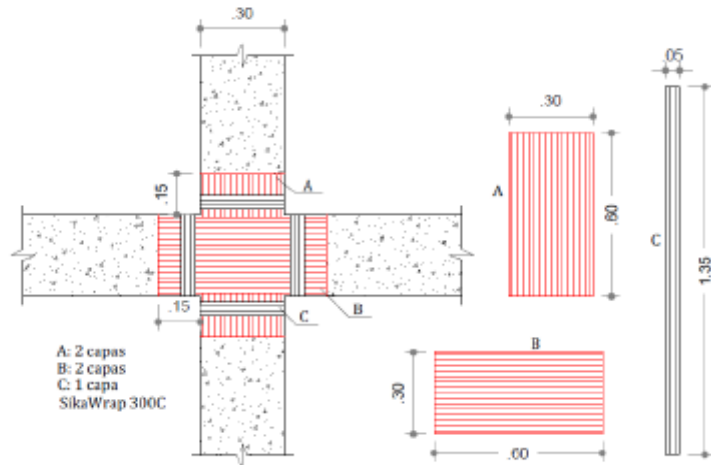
Esquema de Reforzamiento No. 2 – Reforzamiento a Cortante en el Nudo y enchaquetamiento de viga y columna.
